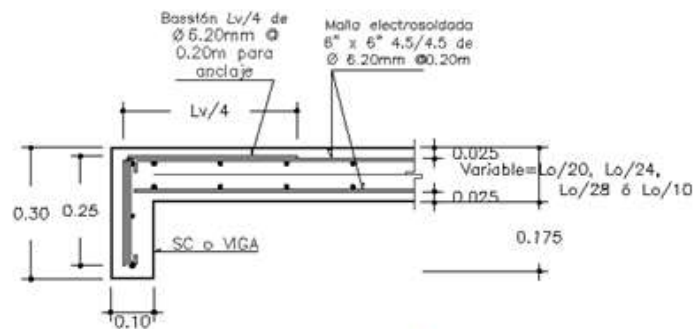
g Apoyo en bordes de losa densa en solera de coronamiento o viga
